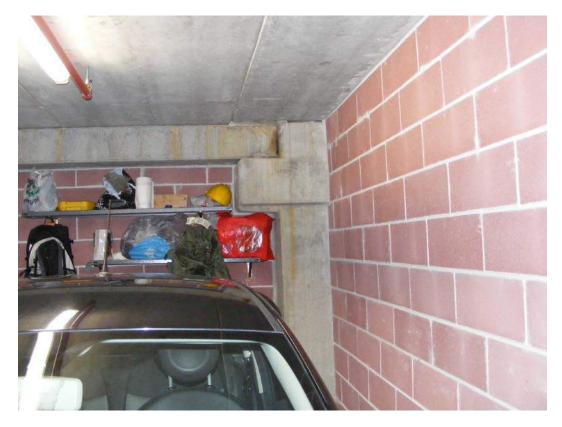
Le infiltrazioni dal solaio dovute alla ventilazione del piano superiore
